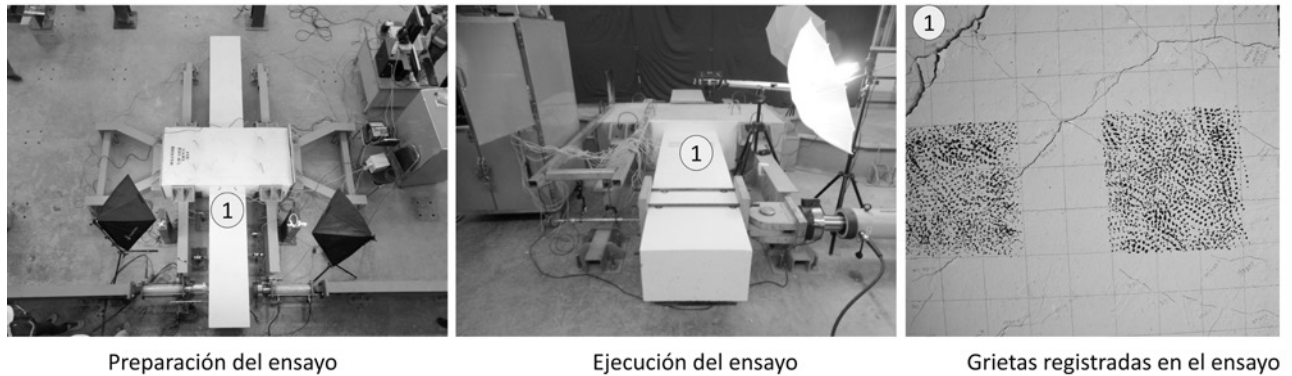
Registro de deterioro superficial en una unión viga-columna de concreto reforzado con fibras de acero adicionada.
